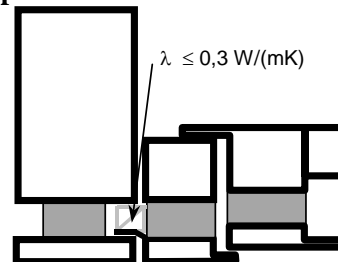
Jonction profilé d'encadrement – traverse/meneau (Type A et Type B)
